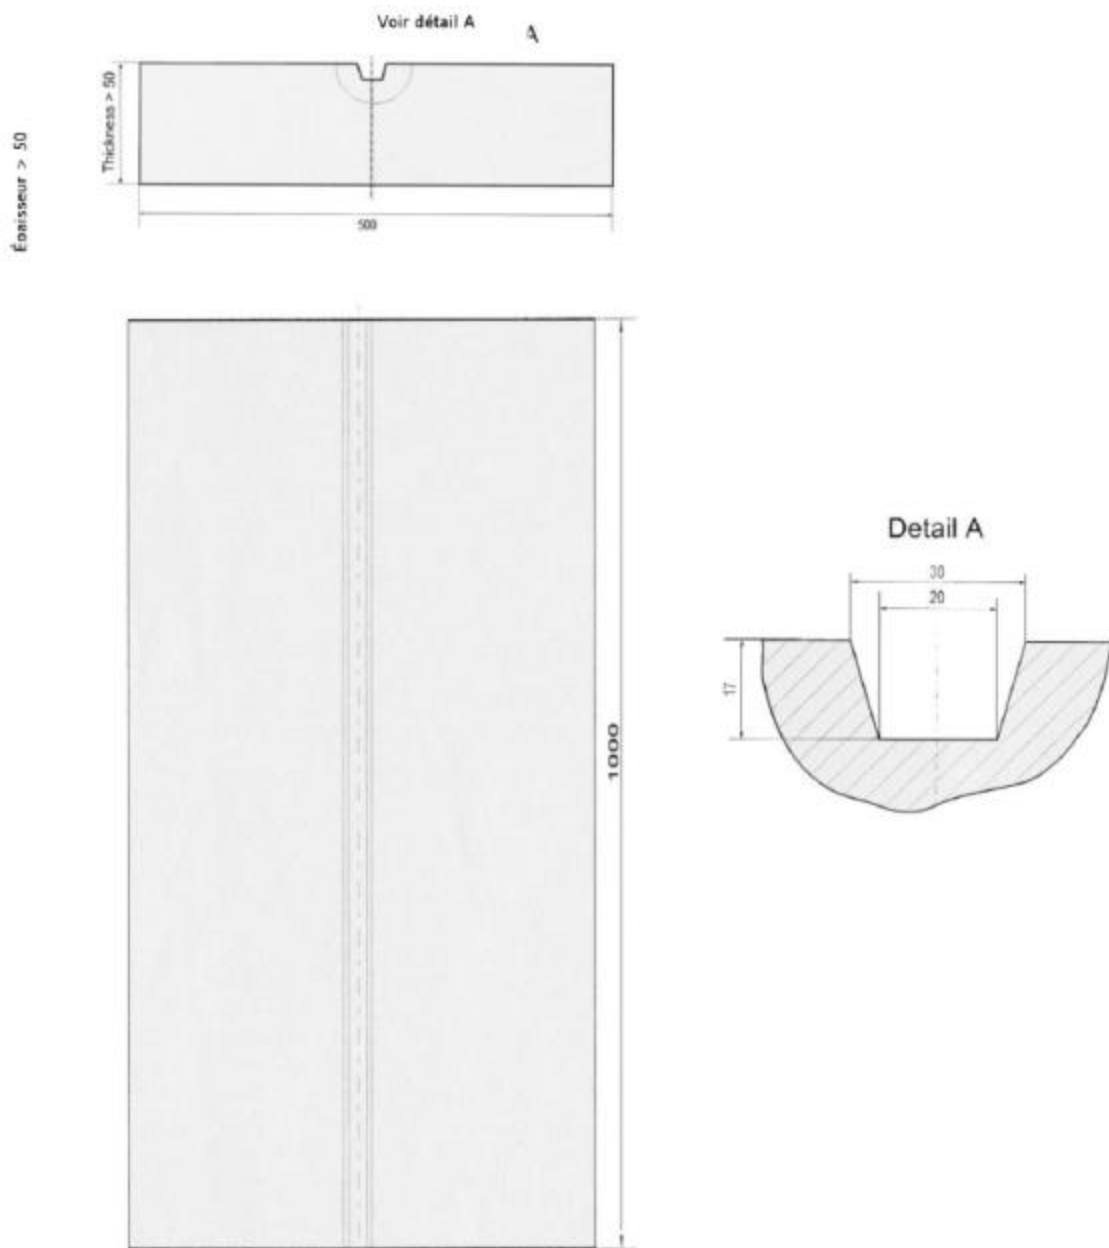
Sto-Panneaux pour Bossage Type I (dimensions en mm)
